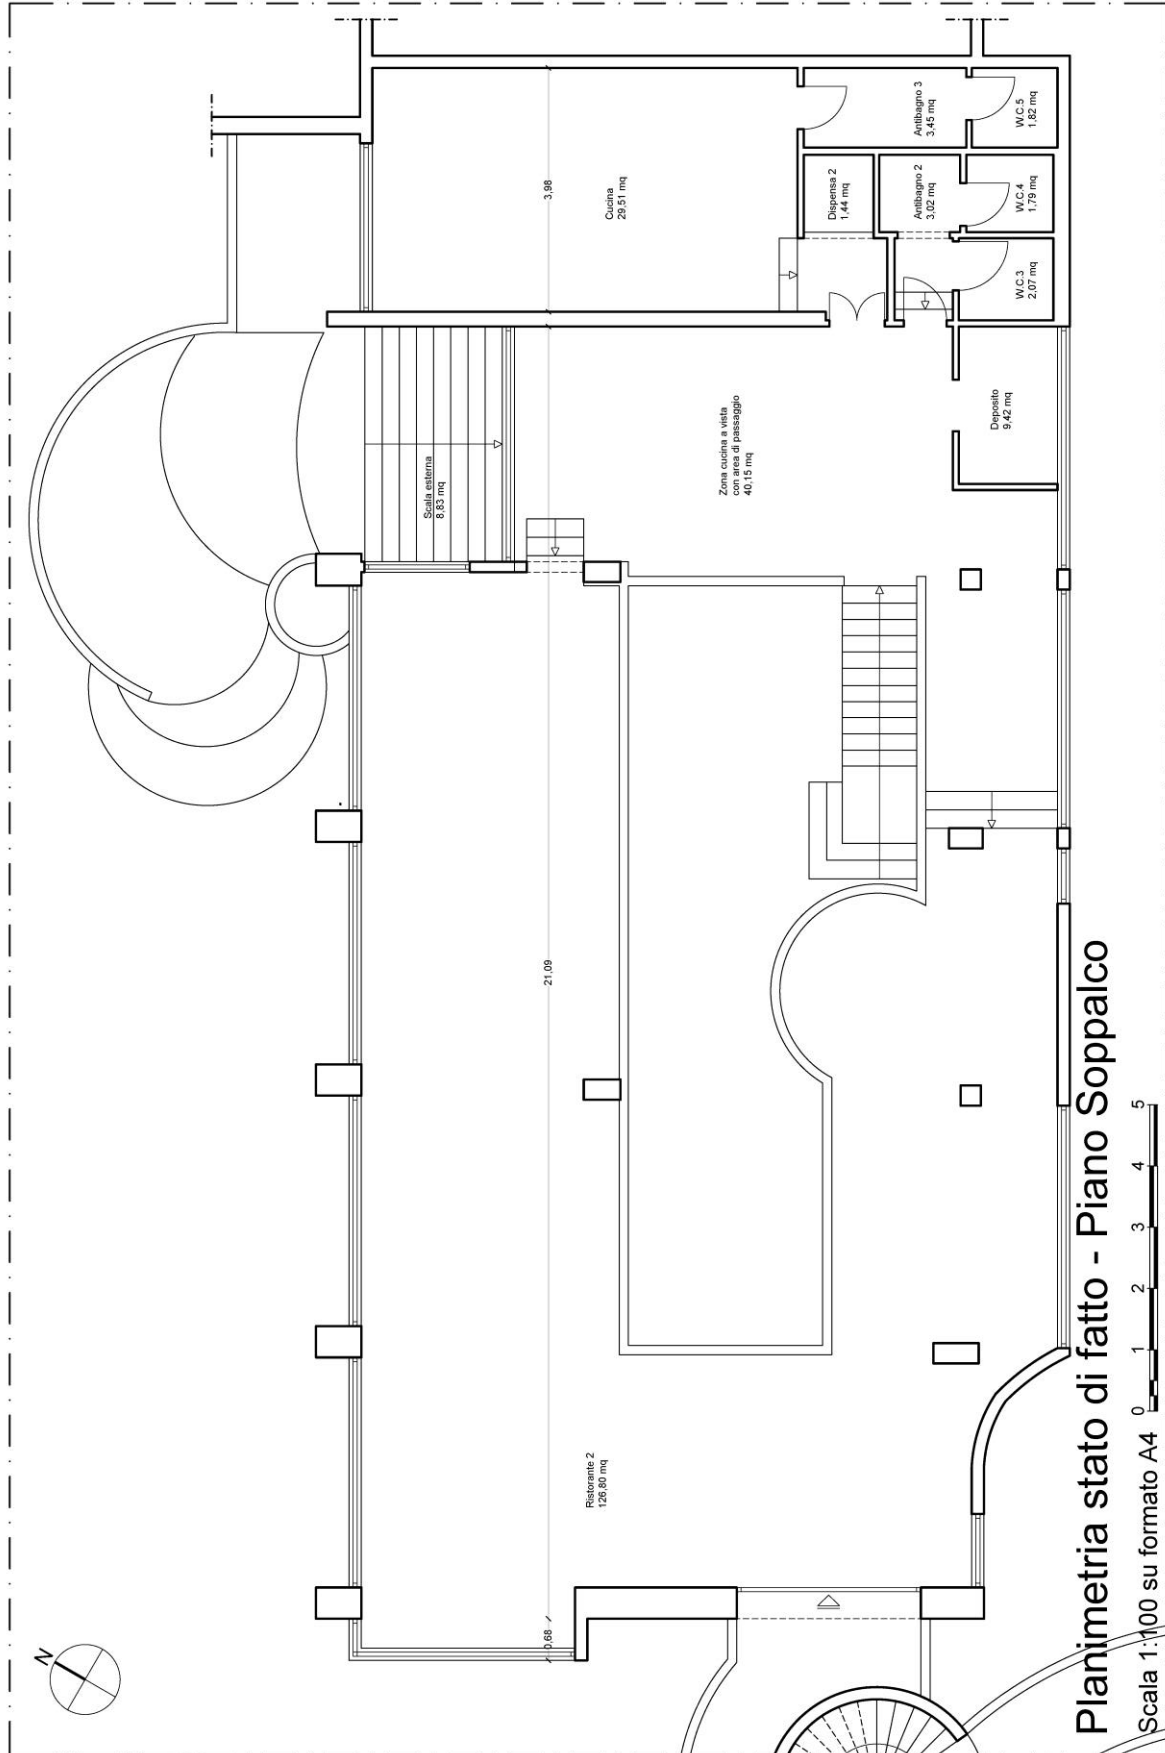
Planimetria dello stato di fatto rilevato – Piano Soppalco
